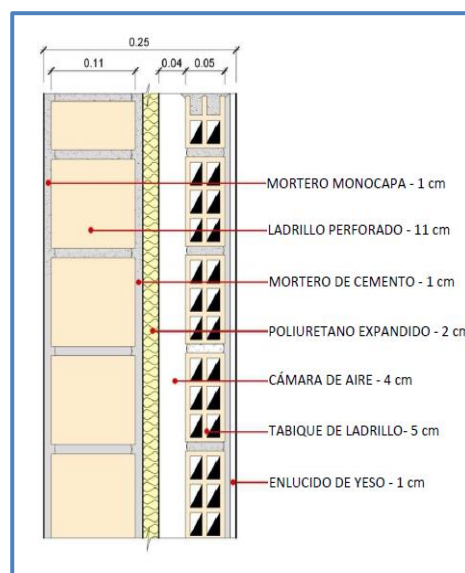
Detalle constructivo de muro revestido
